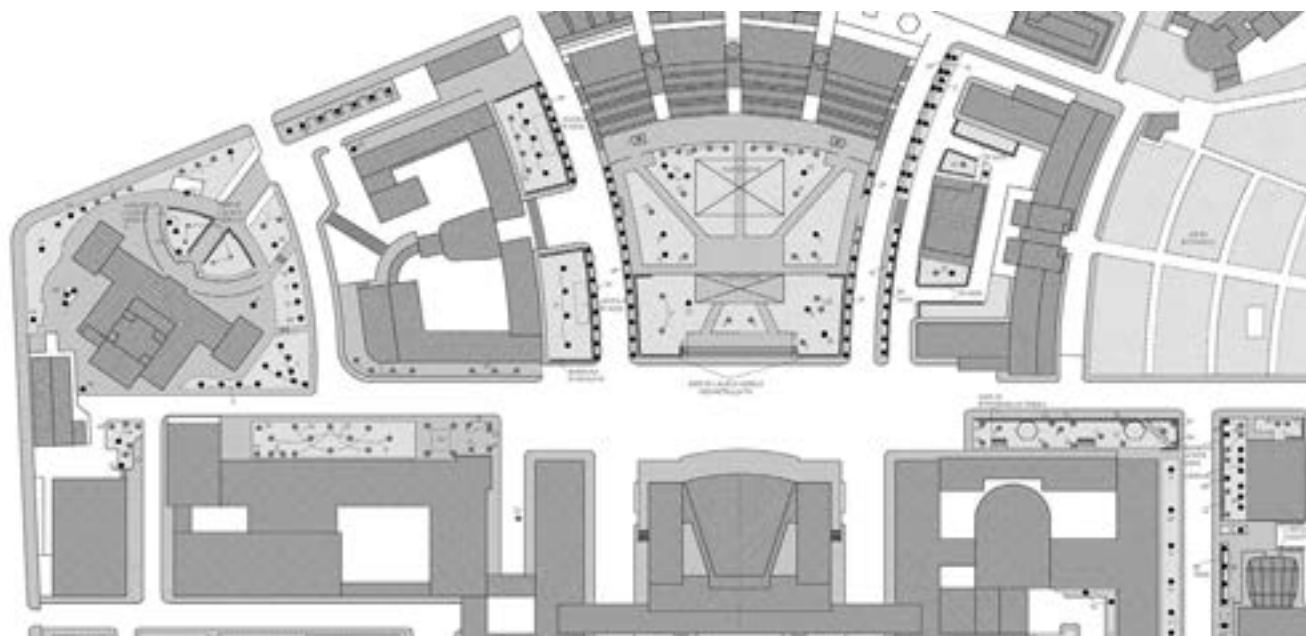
Evidenziazione (pallini grigi) delle piantagioni successive all'impianto originale (elaborazione dell'ing. Felicita Fiorini).
